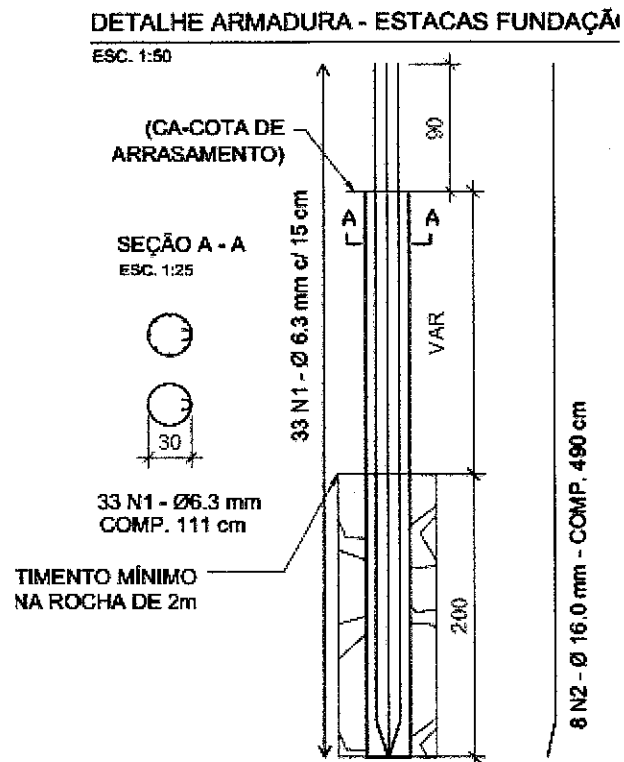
Detalhamento armaduras estacas de fundação - Rua Perú
